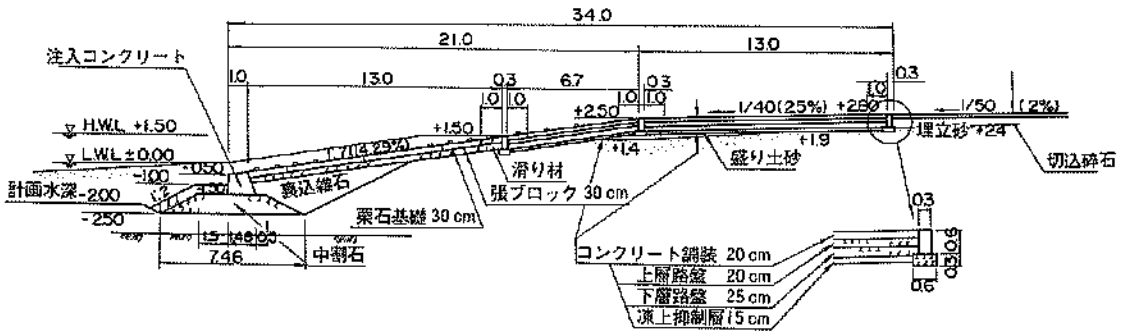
千代ノ浦漁港の⑥船揚場標準断面図
